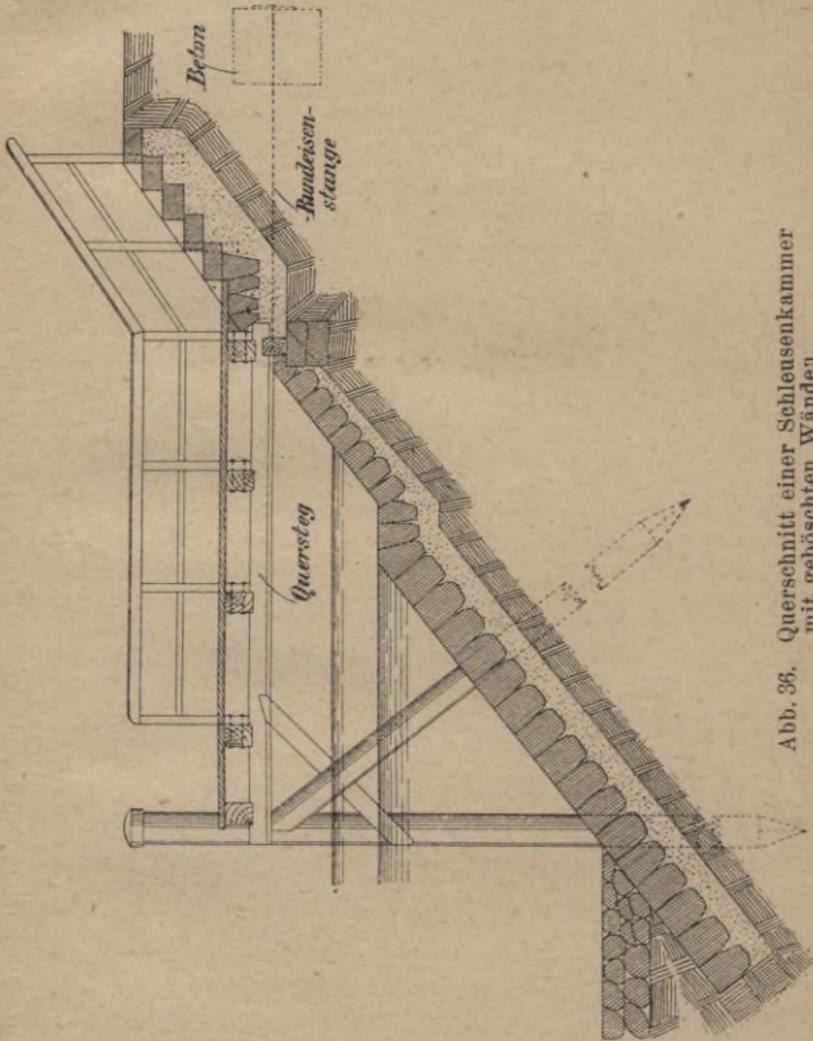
Querschnitt einer Schleusenammer mit geböschten Wänden.
